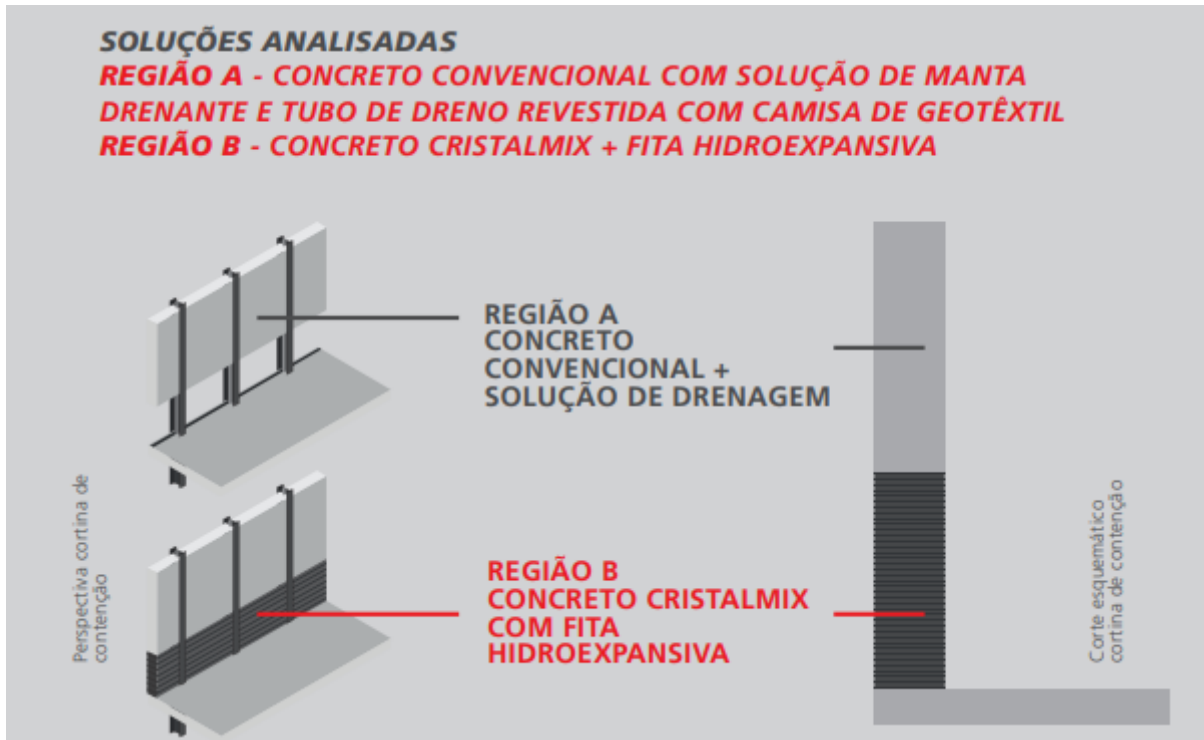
Esquema da aplicação dos dois tipos de concreto
